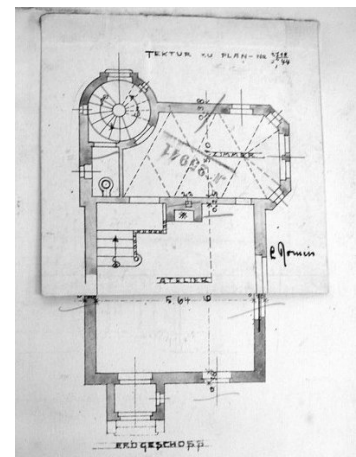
Atelierbau für Karl von Wulffen, Grundriß Erdgeschoß: Tektur, Leonhard Romeis.
